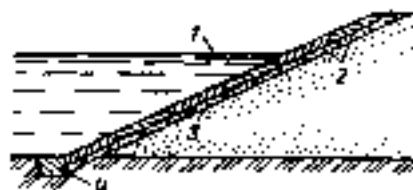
Накріплення укосу настигу залізобетонними плитами:
